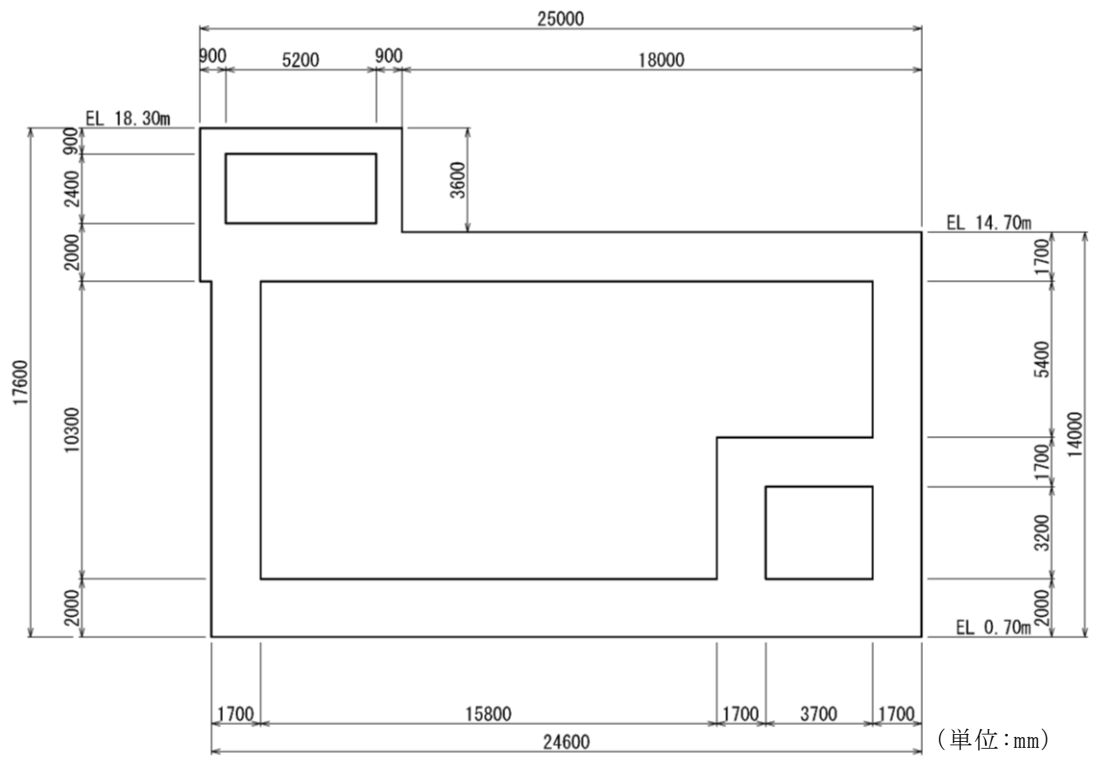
第 1 ベントフィルタ格納槽 断面図 (C-C 断面)
